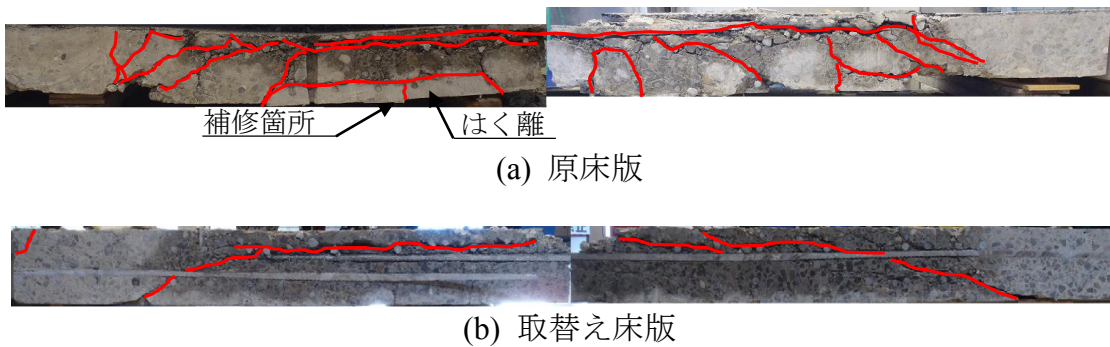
供試体断面の損傷状況(橋軸断面)
